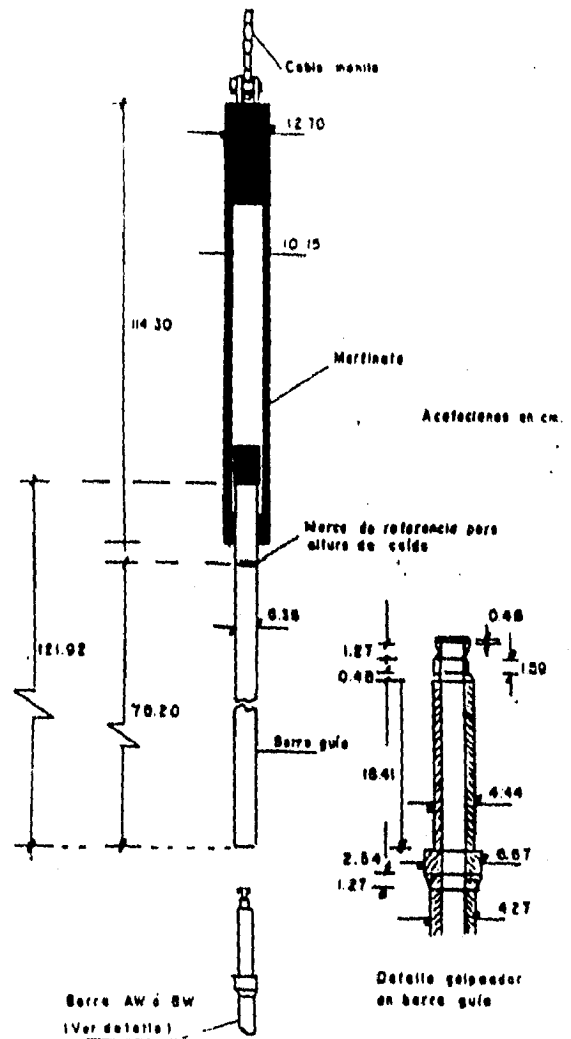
CORTE TRANSVERSAL DEL MARTINETE PARA PRUEBA DINÁMICA.
